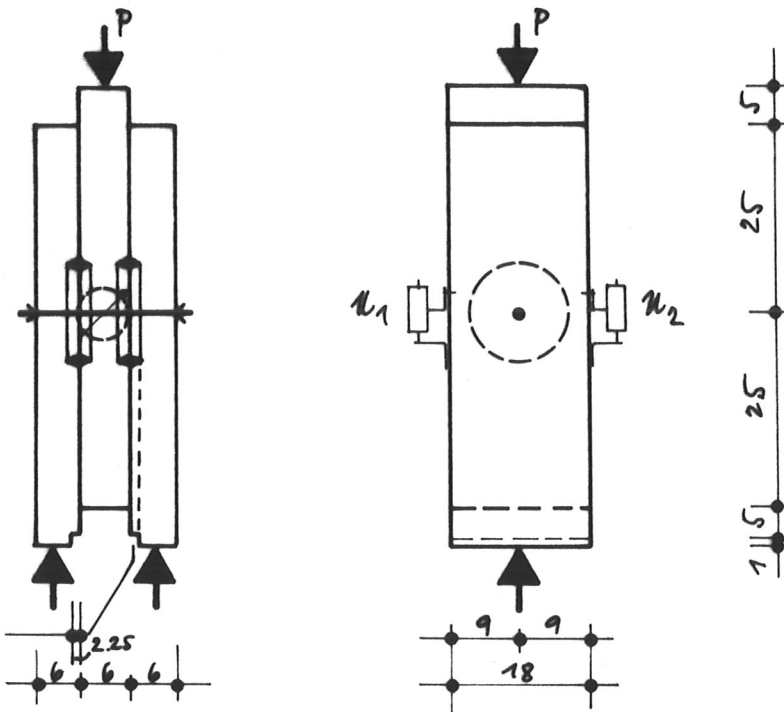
Probekörper für Schwellversuche mit Appeldübeln
